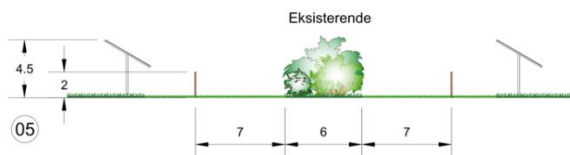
Snit langs eksisterende beplantningsbælte mellem to markstykker nord-øst for gården Mørup.
